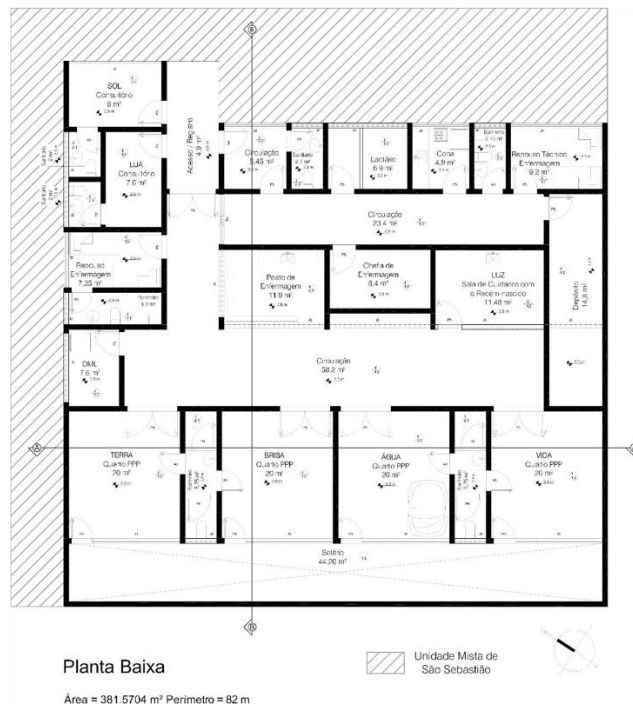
Planta Baixa. Fonte: Agencia Brasília.
